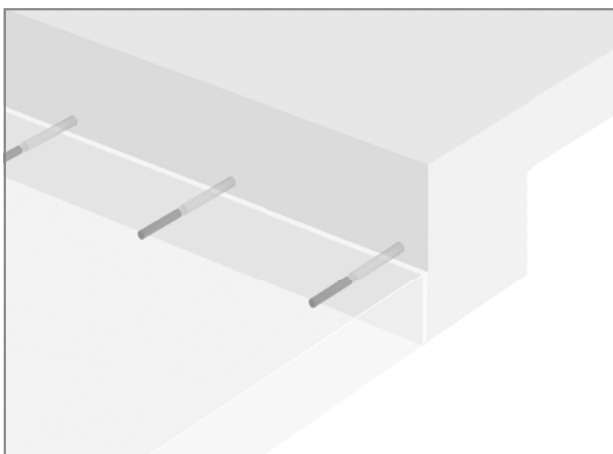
Schöck Dorn type LD : liaison dalle-poutre
